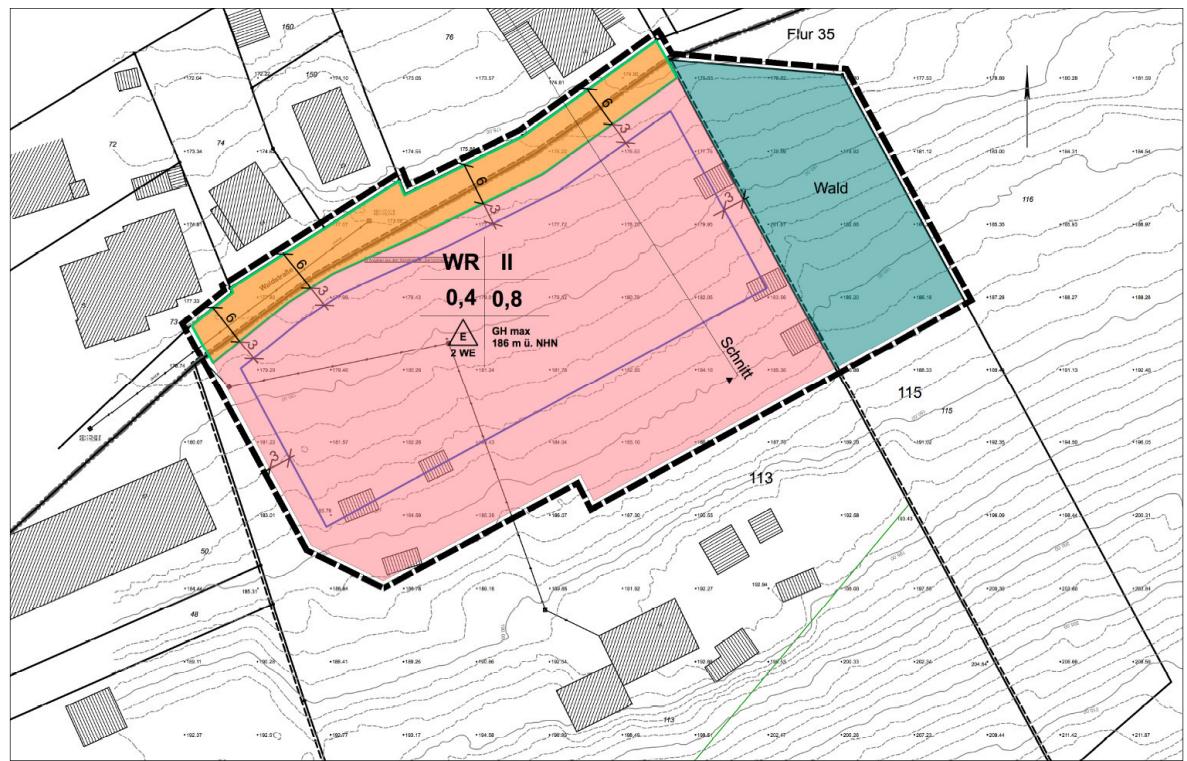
Übersicht des Bebauungsplans "Waldstraße" [1]
